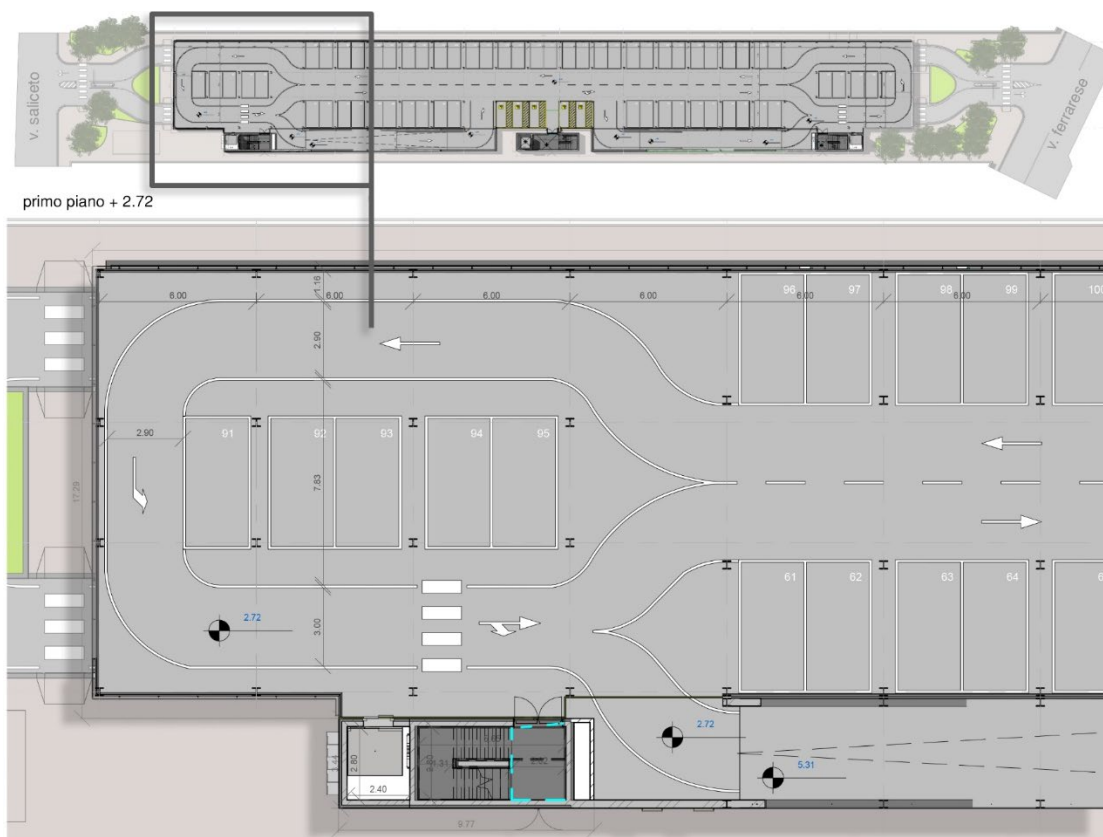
Pianta piano 1 e stralcio del lato ovest
